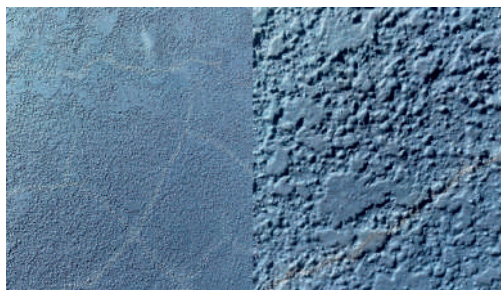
Fissuras mapeadas em fachada texturada (Imagem aberta e fechada)
